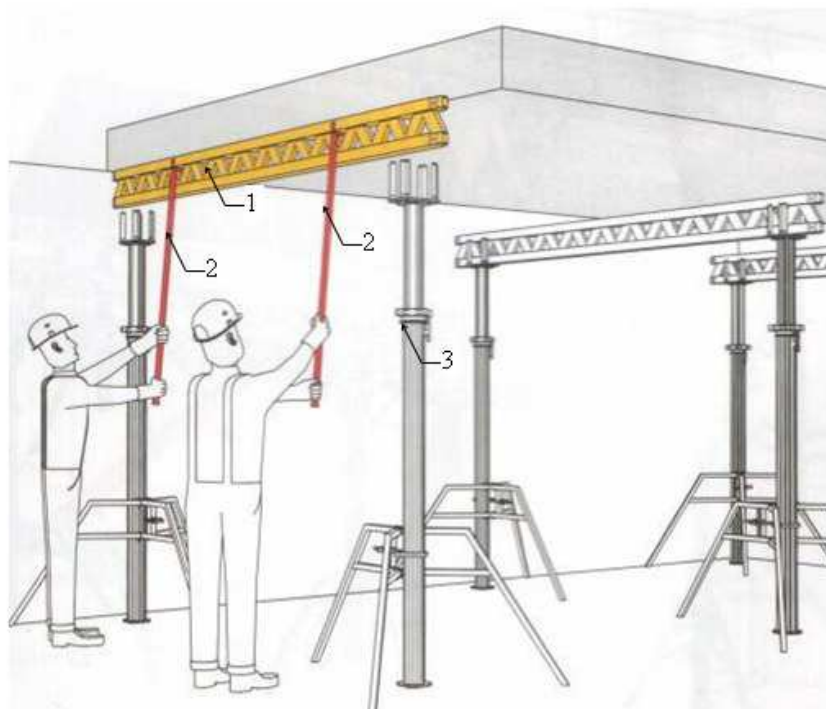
Демонтаж балок настила опалубки: 1 – продольная балка; 2 – монтажная штанга; 3 – основная стойка
